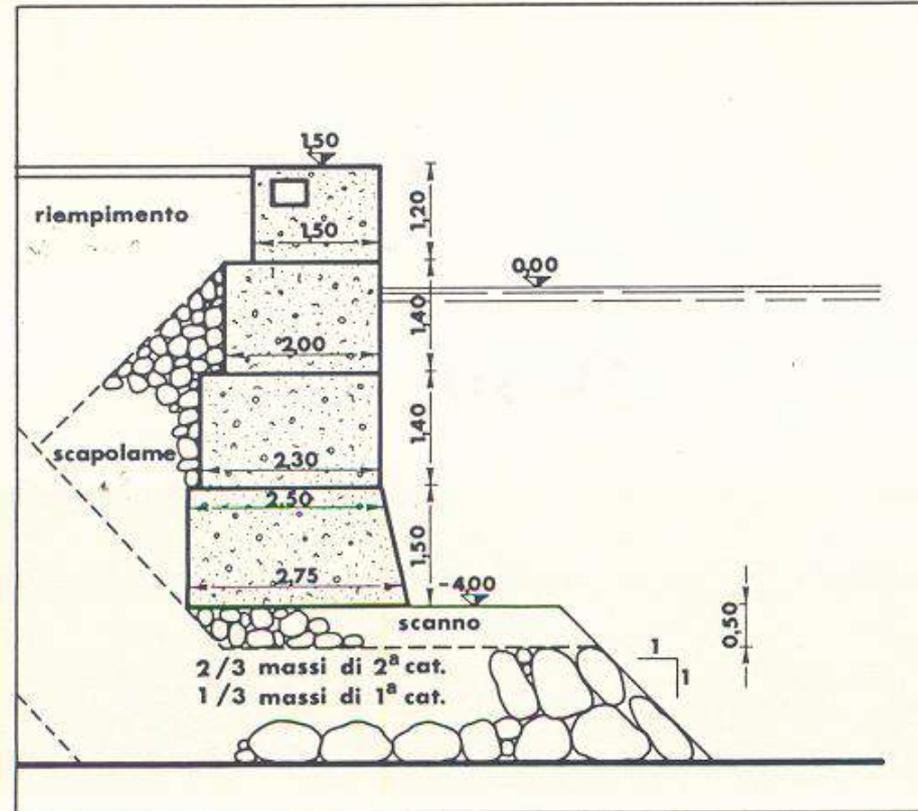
Estructura en muros de concreto, de la sección tipo ANCHURA
